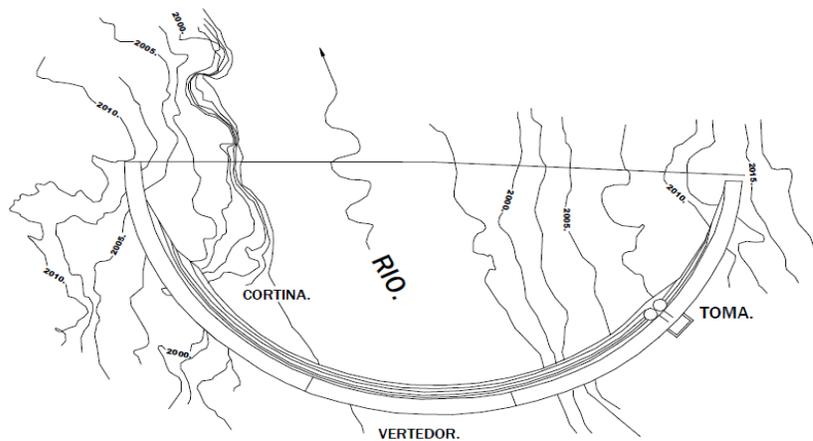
Vertedor de Caída Libre (visto en planta).
